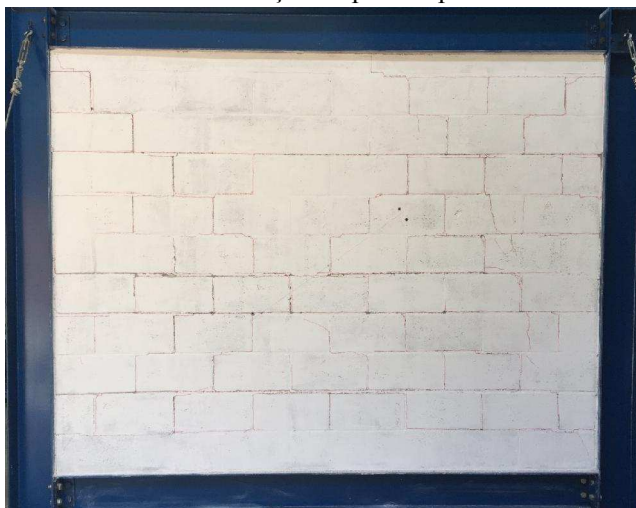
Estado de fissuração do painel após ensaio - PP-2-CE-0.5/2.0
